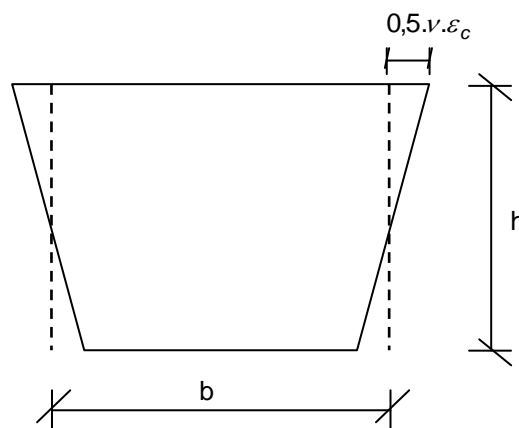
Déformation transversale d'une poutre fléchie longitudinalement
